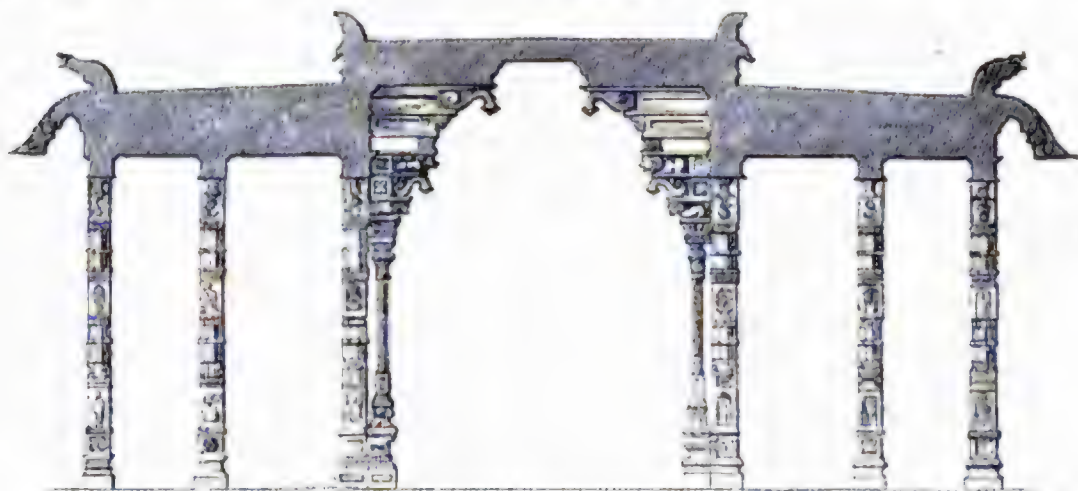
Durchschnitt der Halle zu Eschilamburam.
